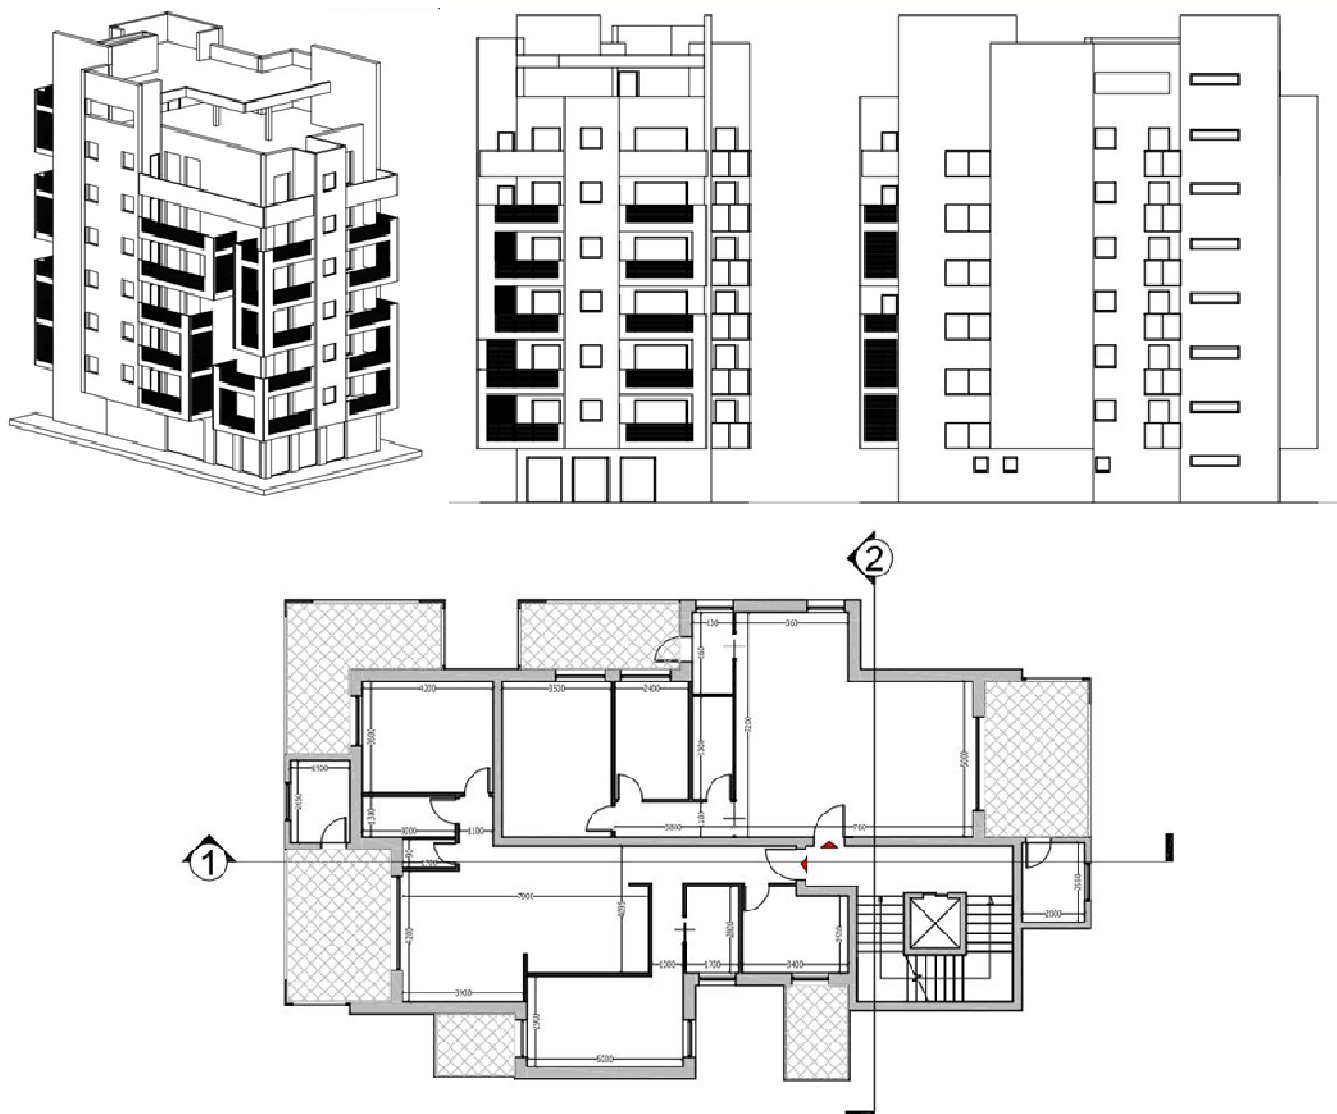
Blocco A5 – Assonometria, prospetto anteriore, prospetto laterale destro e pianta del piano tipo
